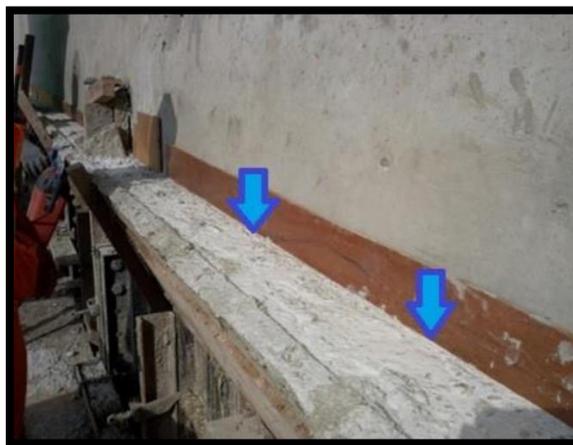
Plancha de fenólico que separa la cachimba del muro.
